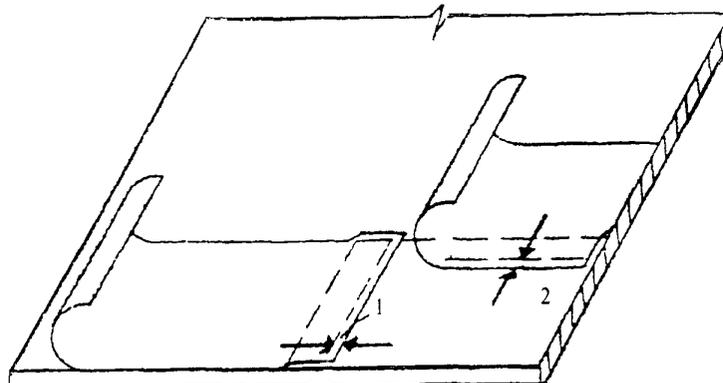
Допускаемые отклонения при устройстве двухслойной рулонной кровли:
